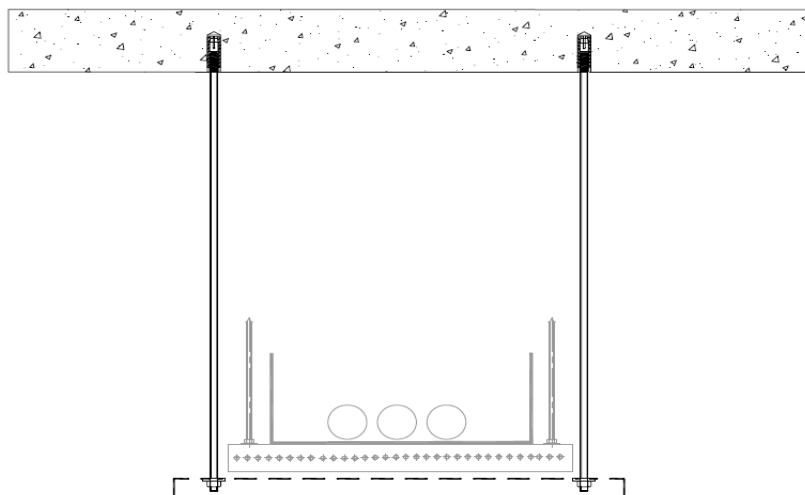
Монтаж системы крепления короба (подвес к перекрытию)
